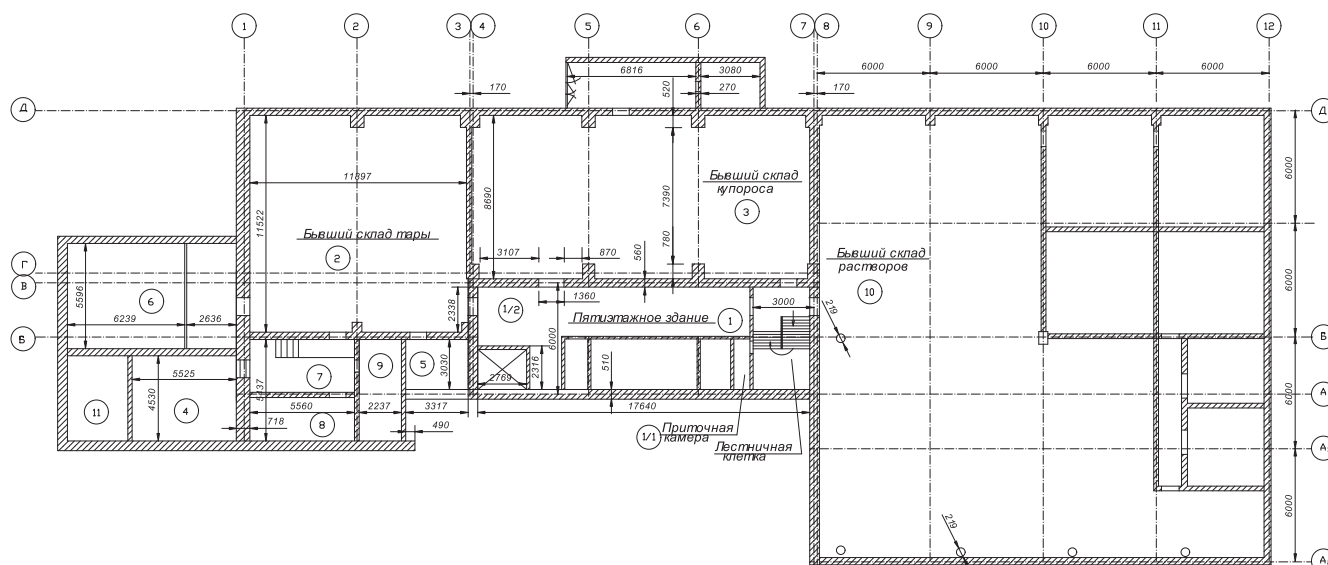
Схематический план первого этажа зданий «Хрустального участка» ТСЦ-3
